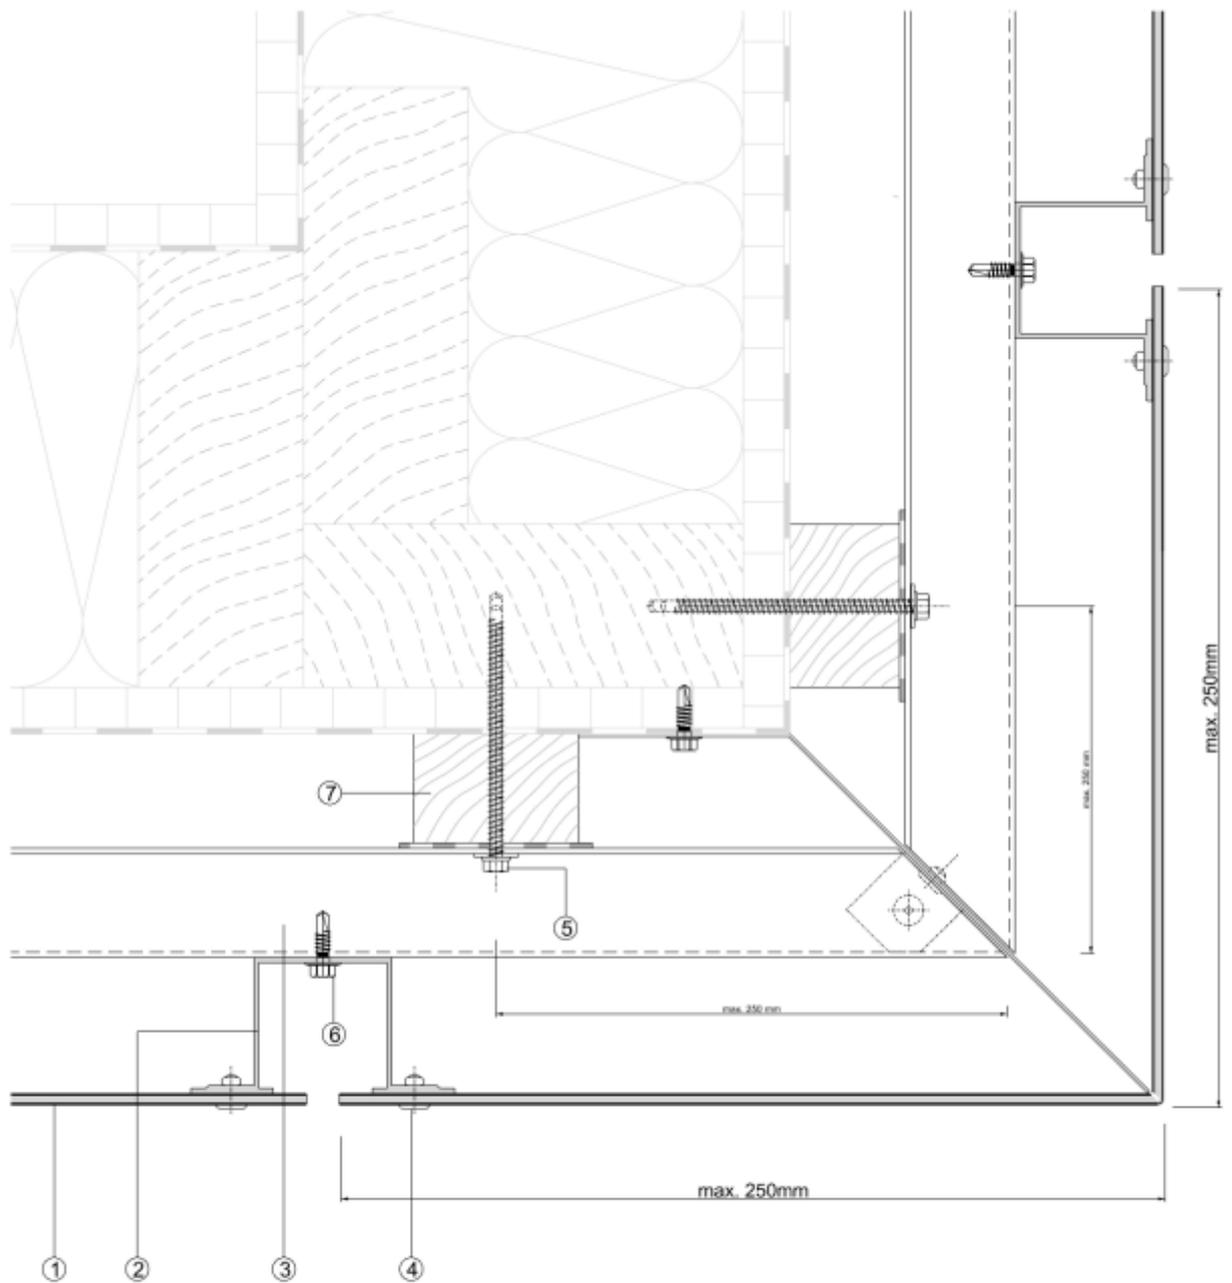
Pose sur COB – Coupe verticale - Triple réseau - Système riveté / vissé – Pied de façade
